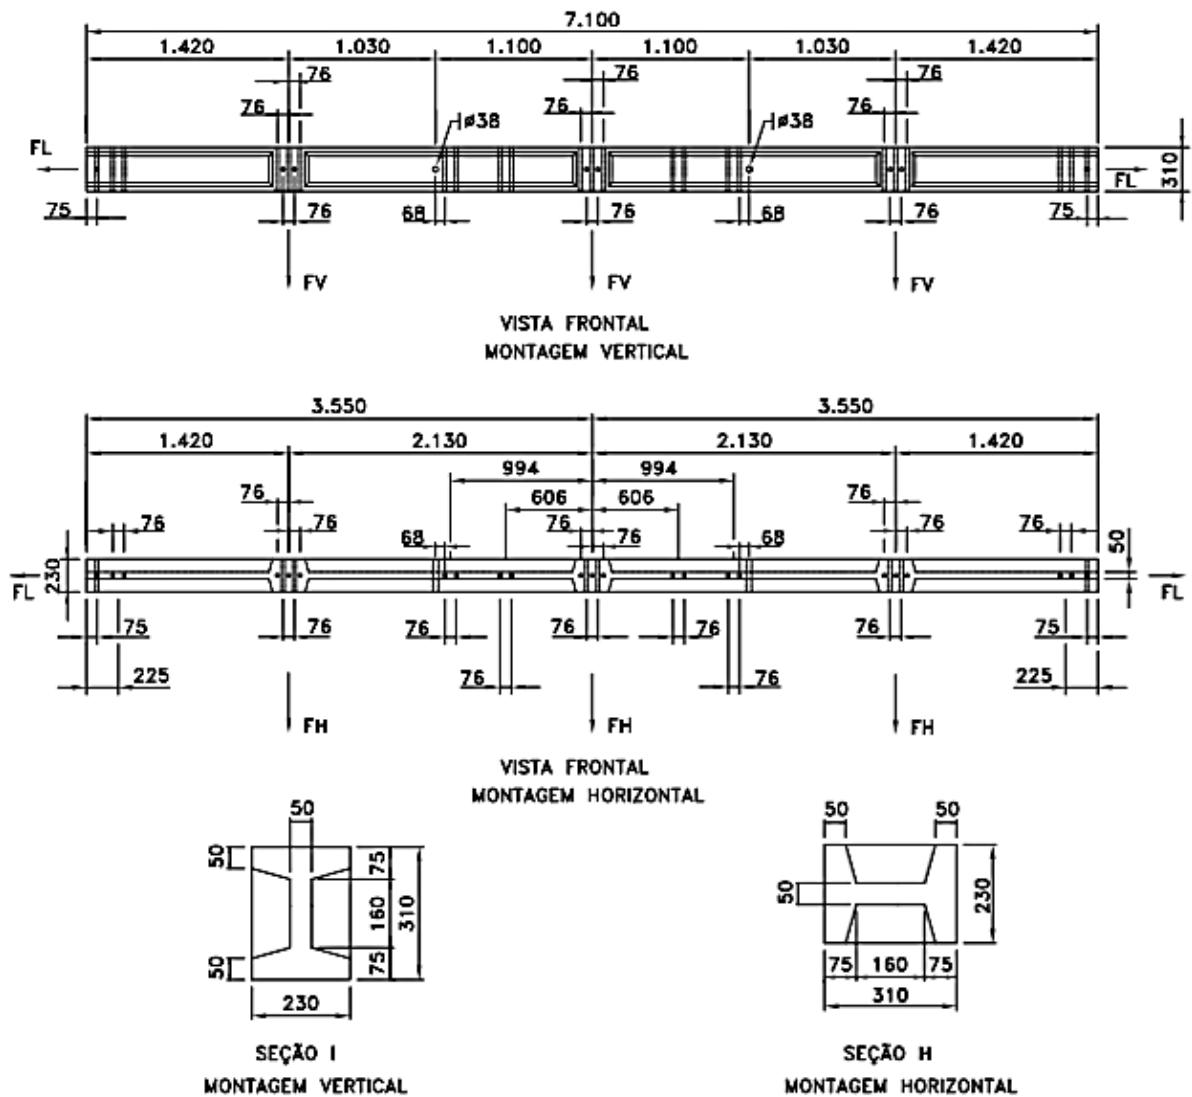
Viga de concreto armado 230x310x7.100mm, montagem vertical e horizontal
